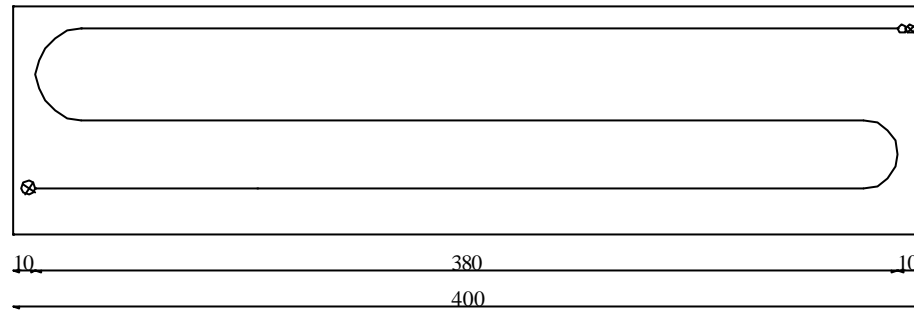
PLANTA DO BLOCO DE TESTES – TFOR, CAMADA SUPERIOR
